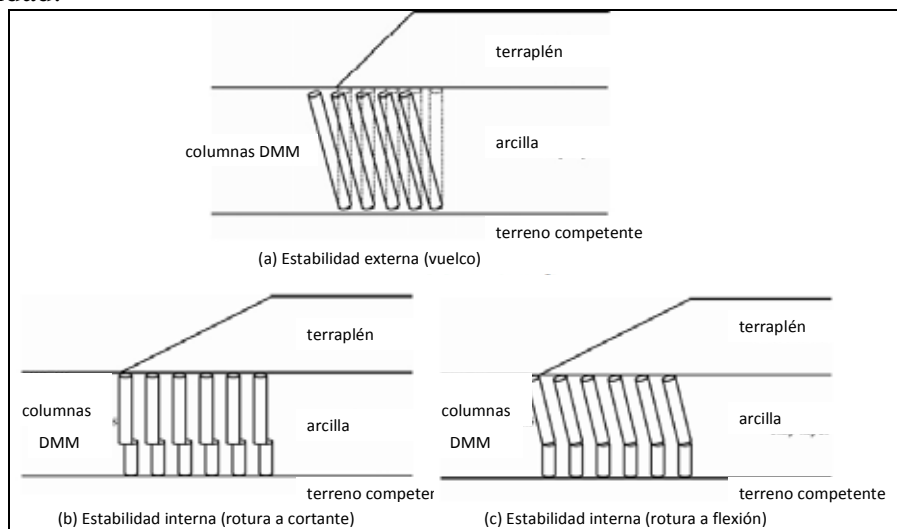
Modos de rotura de las columnas DMM (adaptado de Kitazume, 2008).
